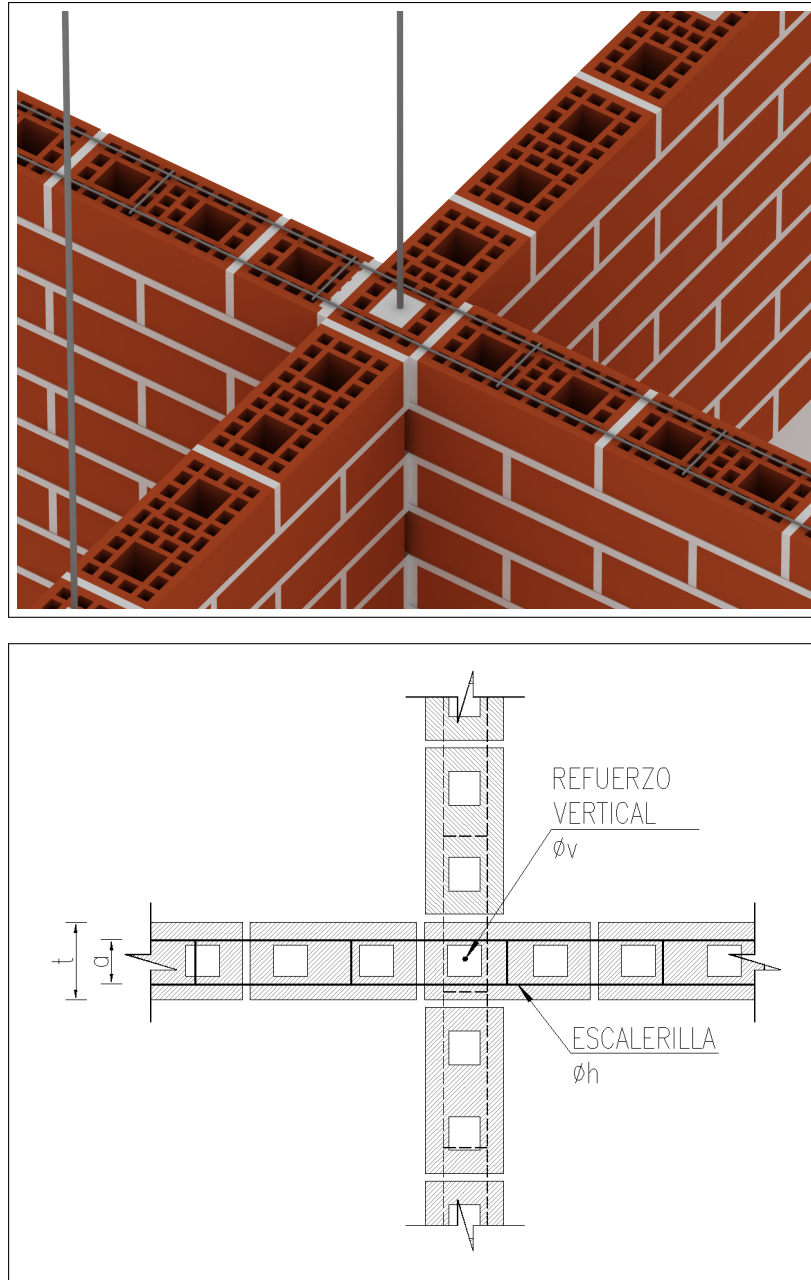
Detalle del anclaje del refuerzo horizontal (escalerillas) en un encuentro de muros en cruz.
